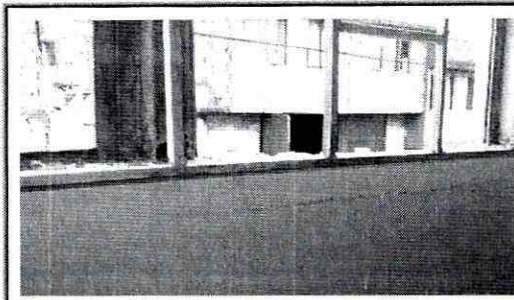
Evidencia de ruptura de ventanales y leves fisuras de tendencia horizontal en muros de fachada del predio de la Carrera 69R No. 75-02.
